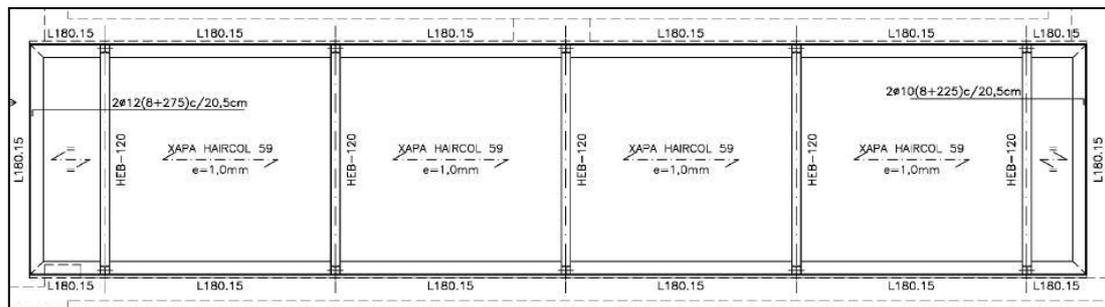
Estructura de vigas a nivel de losa. Vista en planta.
